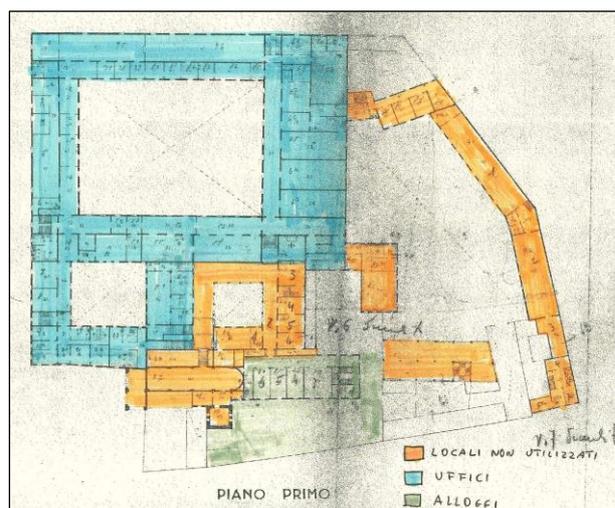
Min. Difesa - *Inventario* – Planimetria del piano primo (1939-1944)
